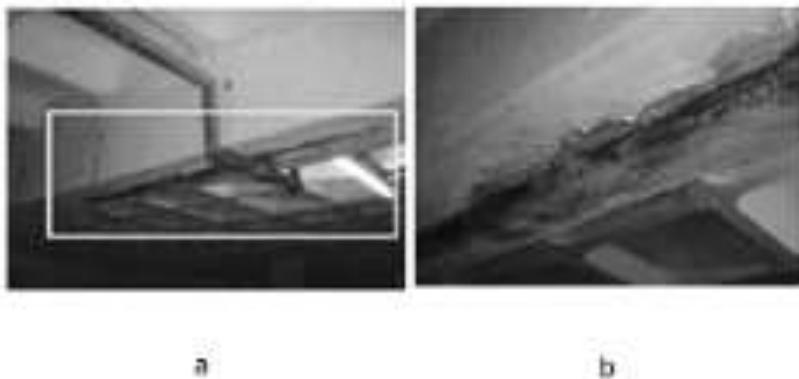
a, b – Infiltração, estufamento de seção, trincas, descoloração de pintura e fungos provocados pelas infiltrações nestas áreas
